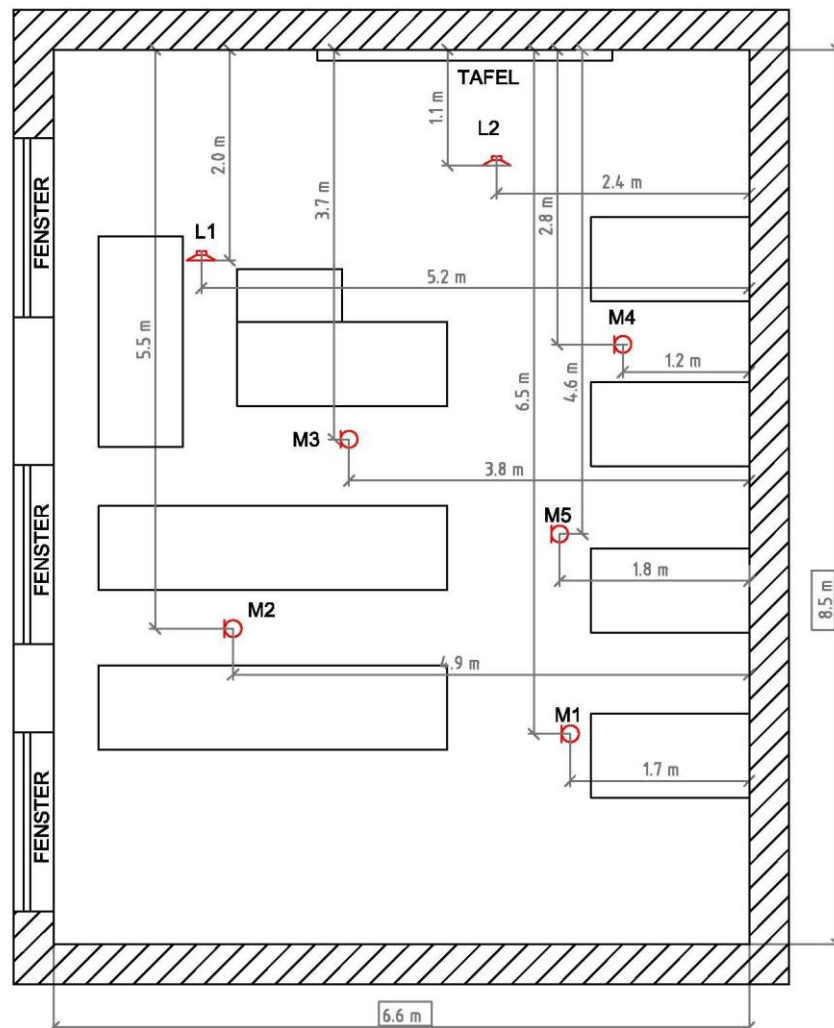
Grundrissplan und Messanordnung in Raum 002
